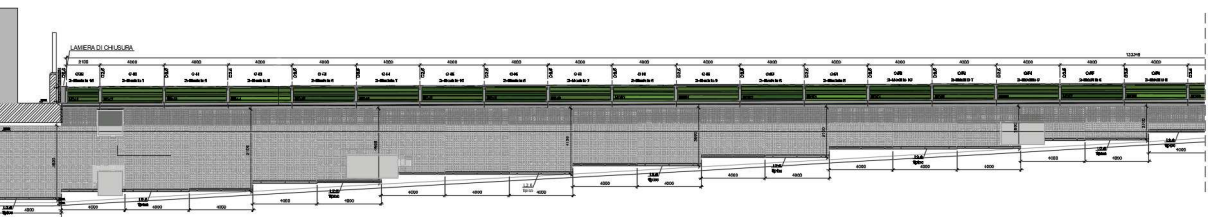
Prospetto della barriera dell'ambito 2 – lato ferrovia
